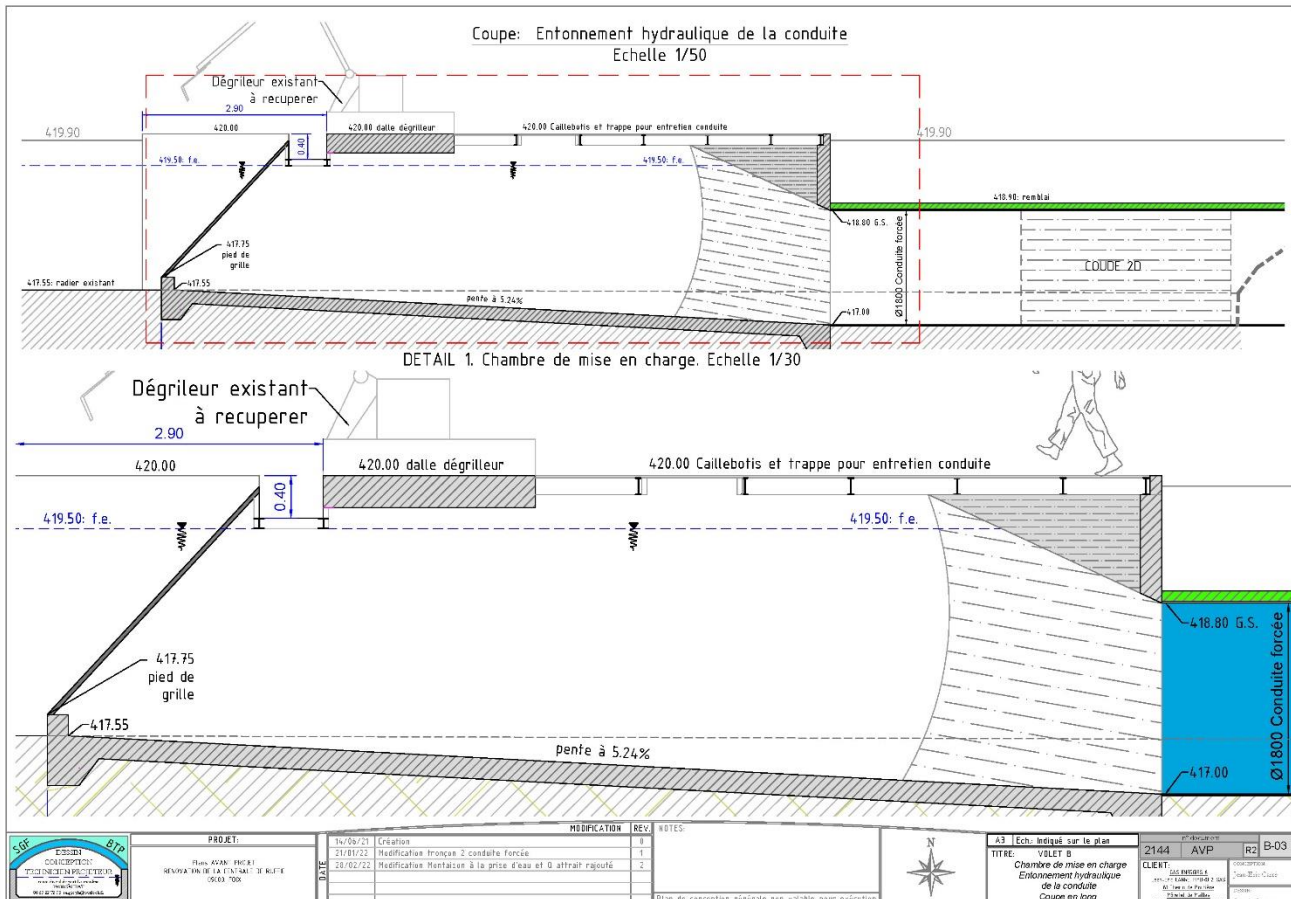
Dessins techniques vue en coupe de la chambre de mise en charge
